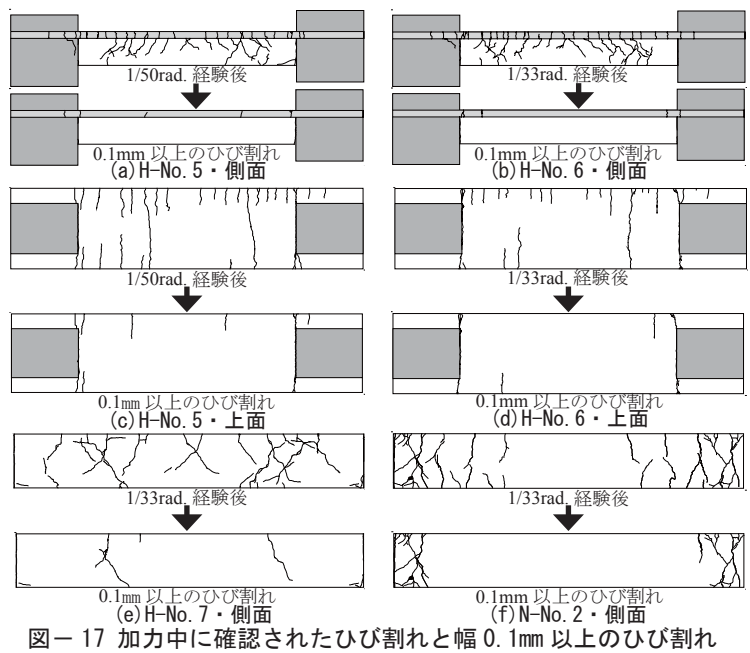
加力中に確認されたひび割れと幅0.1mm以上のひび割れ
